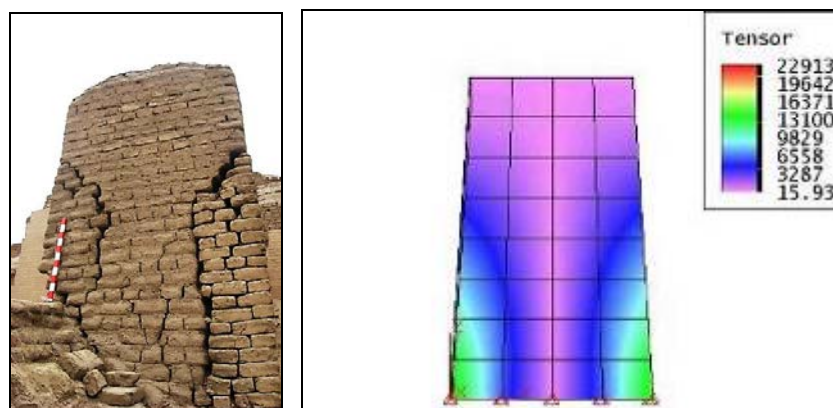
Muro de sección trapezoidal y modelo matemático que interpreta su comportamiento estructural bajo cargas dinámicas, los agrietamientos se forman con un esfuerzo de $0,13 \text{ kg/cm}^2$.
